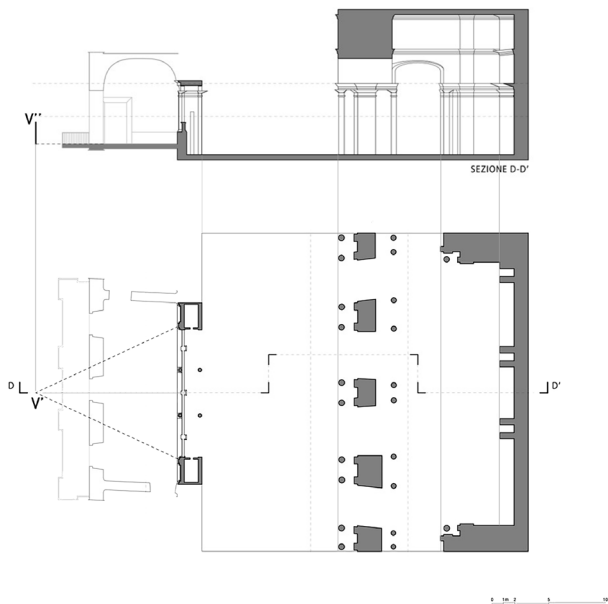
Restituzione prospettica di ulteriori elementi architettonici dipinti attraverso gli allineamenti prospettici tra centro di proiezione, immagine prospettica e posizione spaziale coerente con gli elementi architettonici precedentemente restituiti (elaborazione grafica delle autrici).
